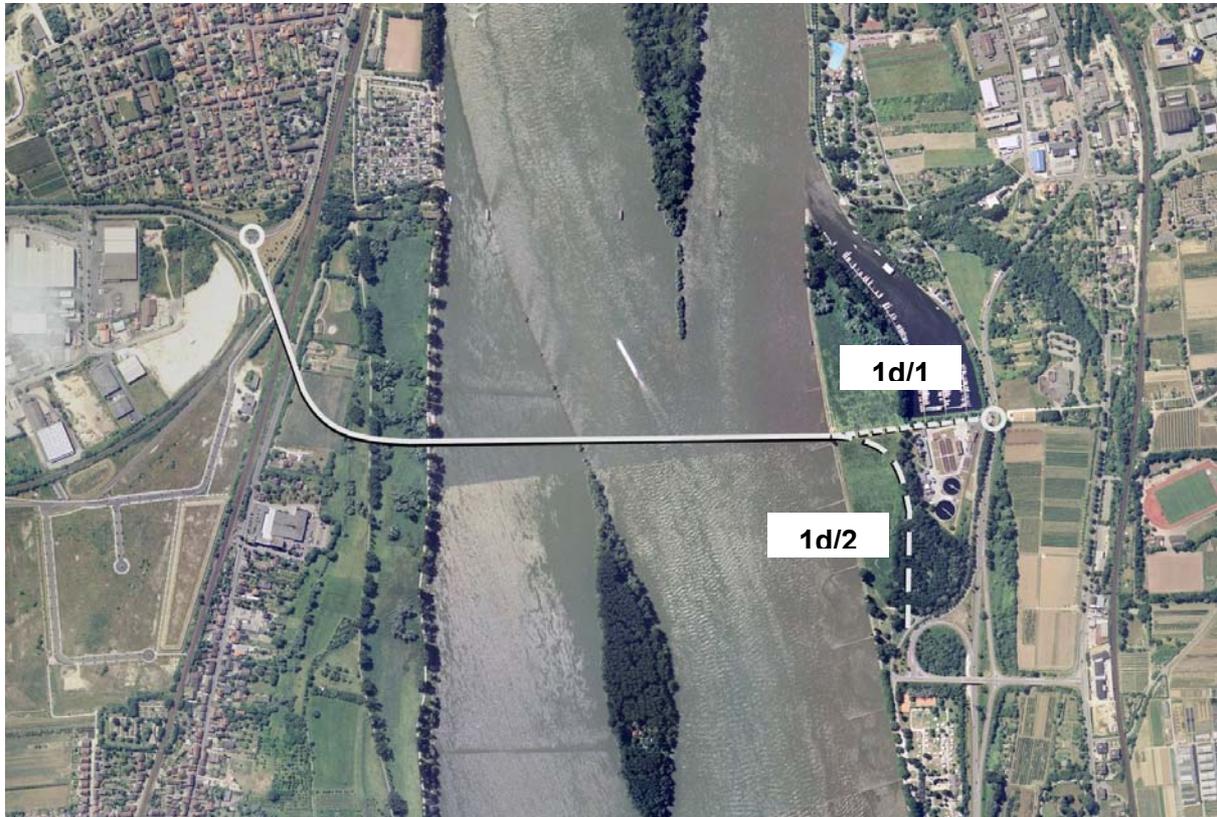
Schematische Darstellung, Standort 1, Variante 1 d, Anschlussalternativen 1d/1(R) und 1d/2(R)
